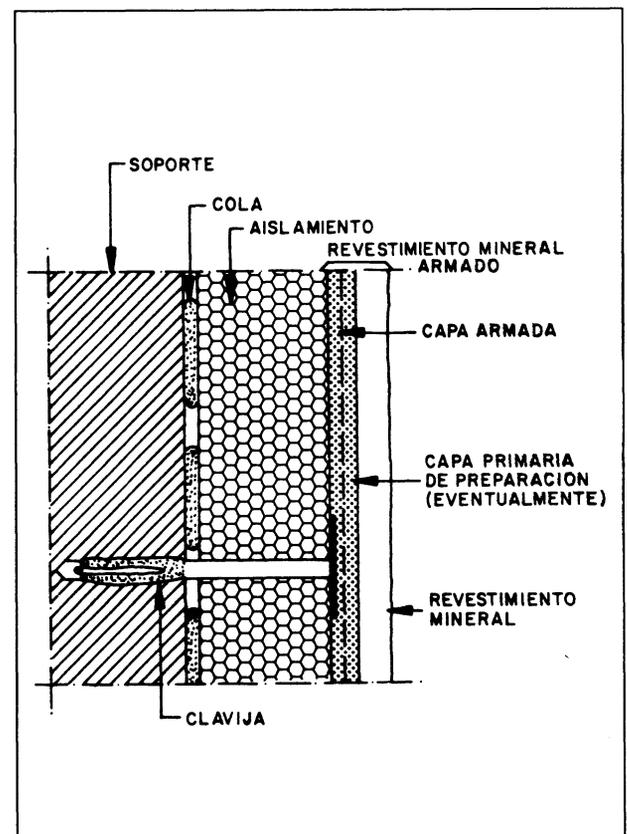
Esquema del sistema de Aislamiento exterior de fachadas con revestimiento mineral
